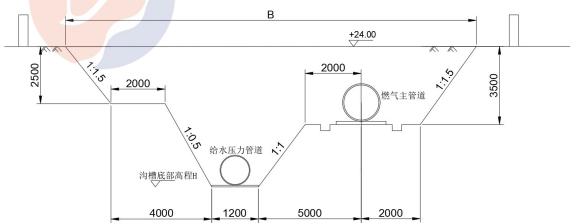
沟槽开挖断面图 (高程单位为 m, 其他单位为 mm)
